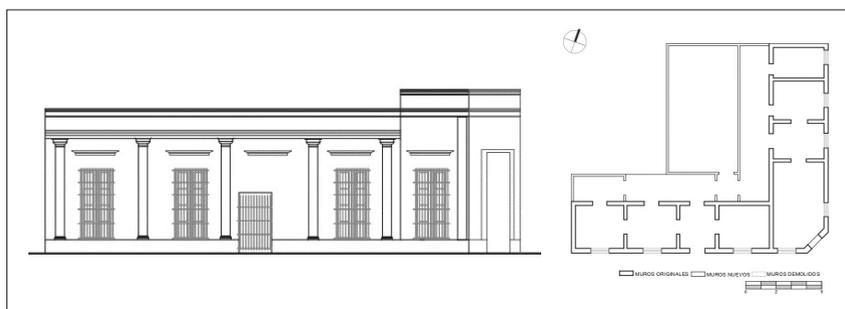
Vista y planta de la escuela. Relevamiento 2019
